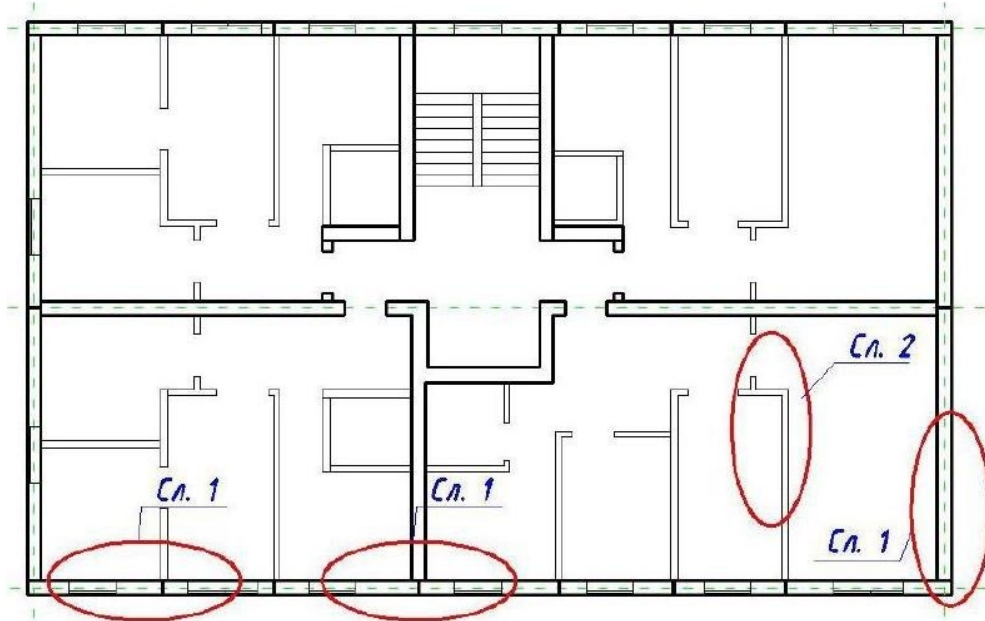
Схема розташування локальних руйнувань типового поверху панельного будинку
